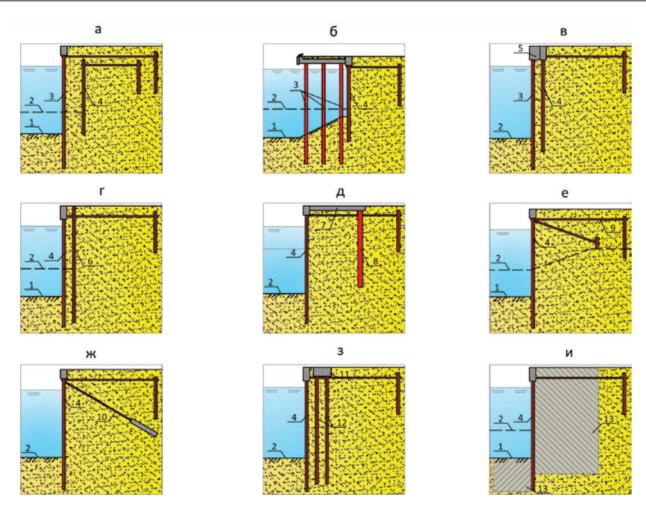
Схемы реконструкции и усиления больверка путем устройства [1]:
